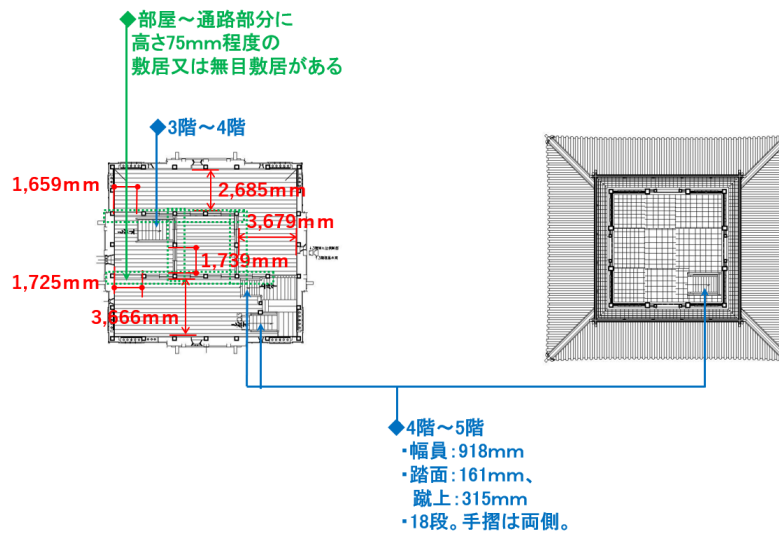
天守4階平面図及び天守5階平面図（復元原案）（復元原案）
